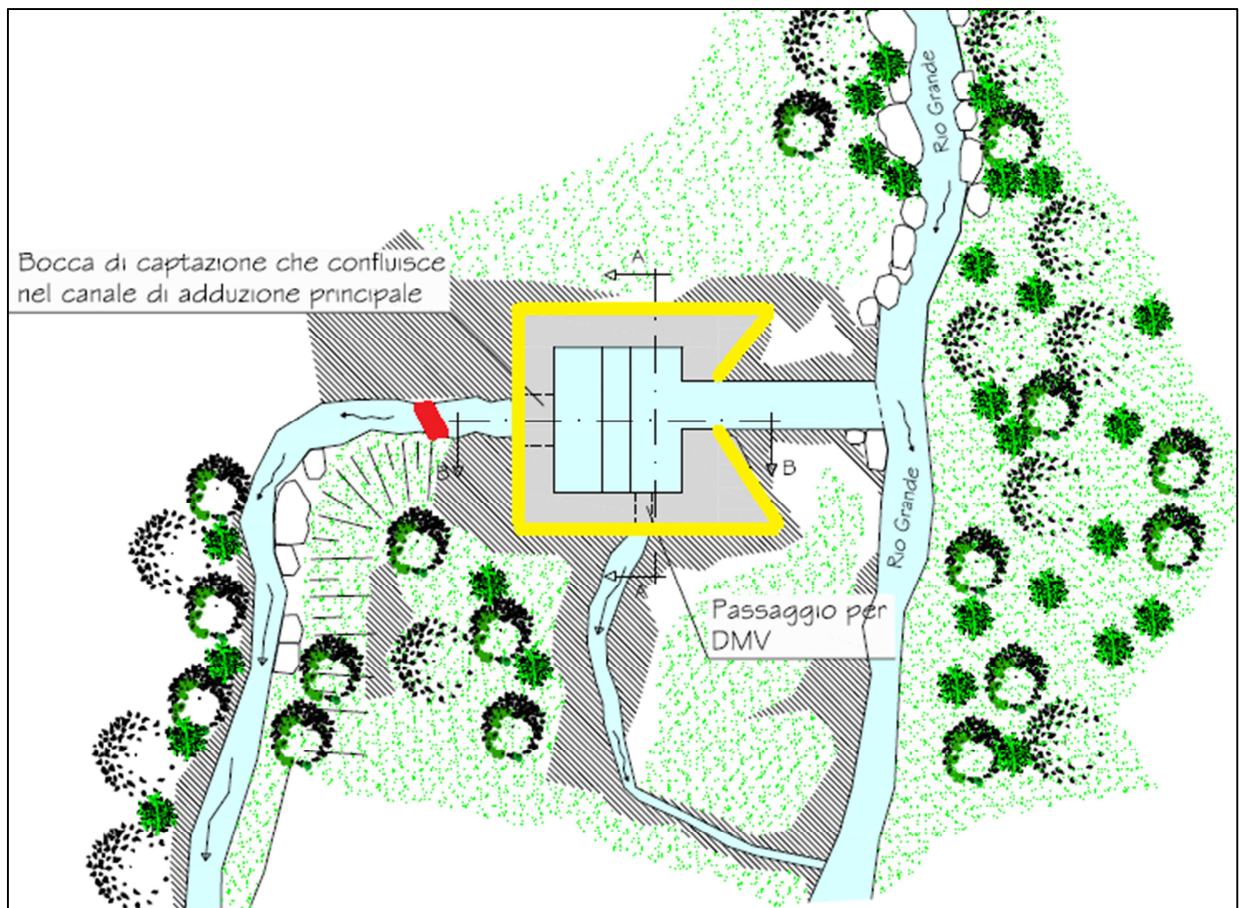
Schema degli interventi previsti: con il contorno giallo è stato evidenziato il pozzetto di cui è prevista la demolizione mentre il tratto rosso indica l'ostruzione da realizzare sull'imbocco del canaletto per evitare che l'acqua possa entrare nella derivazione
